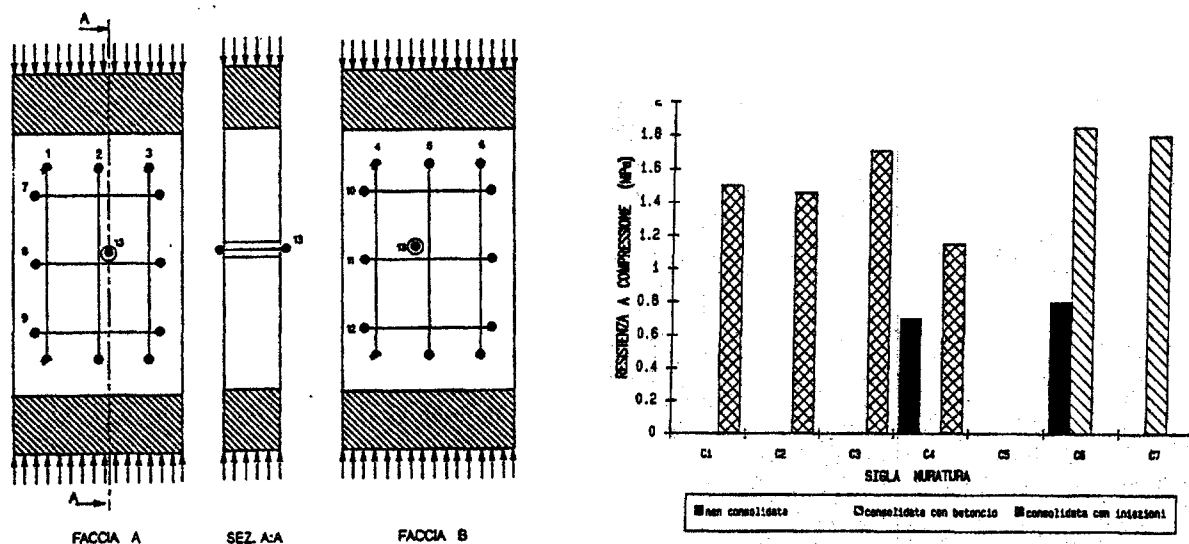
Prove a compressione su murature consolidate con iniezioni e lastre armate (Bettio et. al, 1993).
